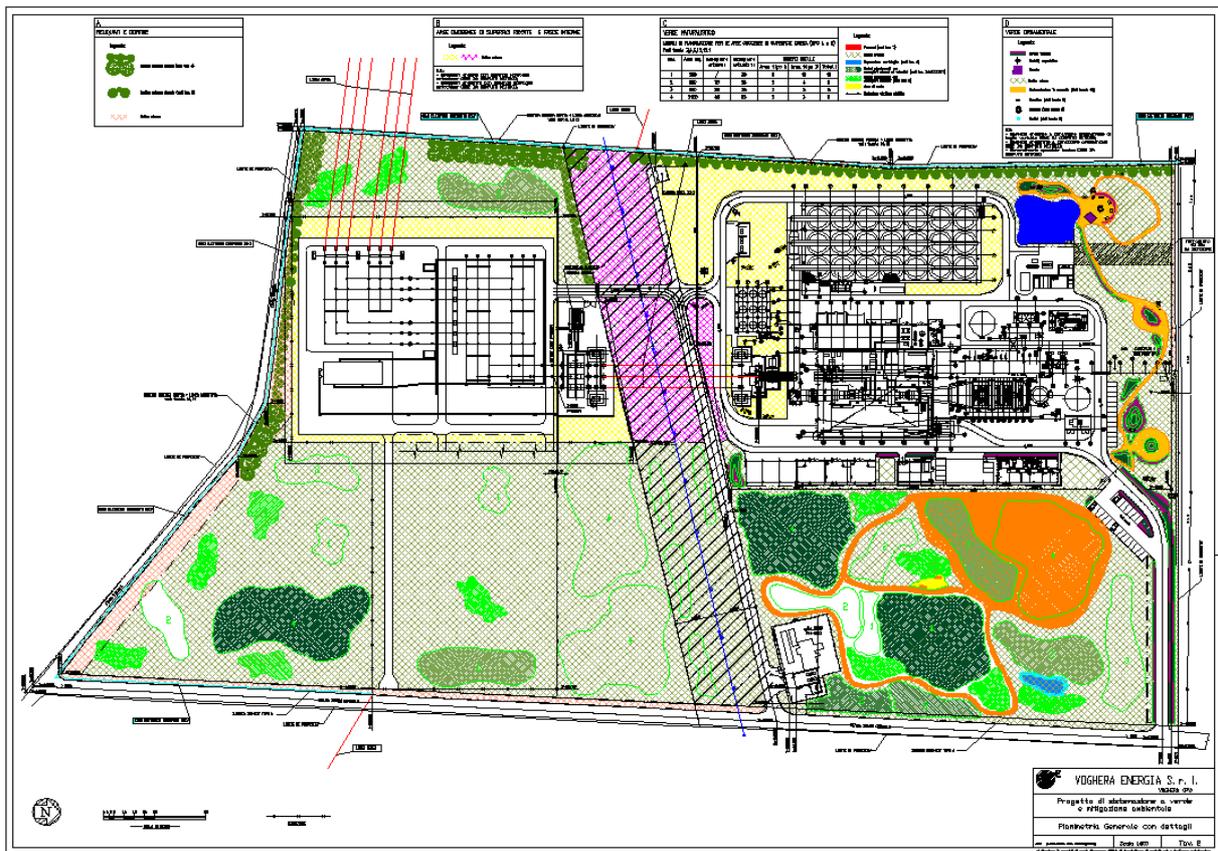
Planimetria con l'individuazione delle aree interessate dalla messa a verde
